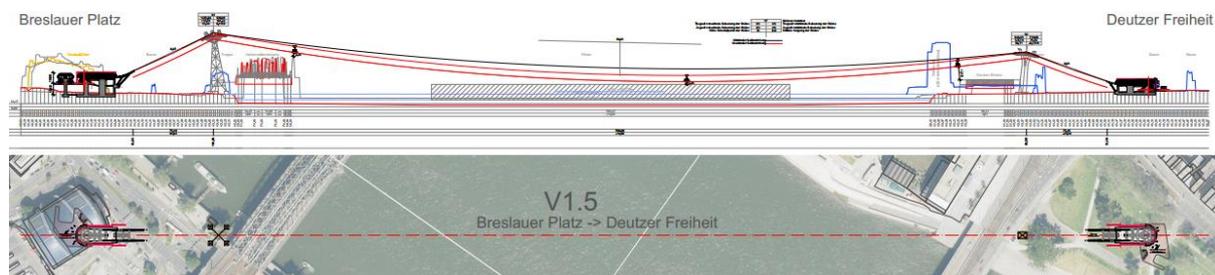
Längenschnitt, Lageplan Variante V1.5
